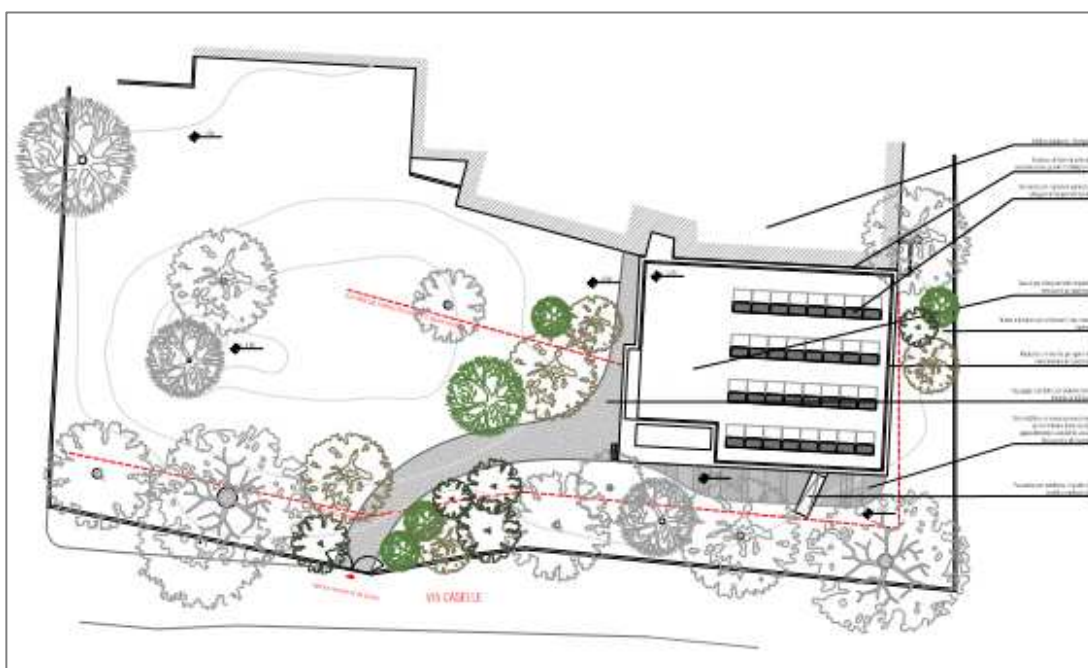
Planimetria del giardino della scuola primaria "Pezzani" e dell'edificio mensa in progetto.
